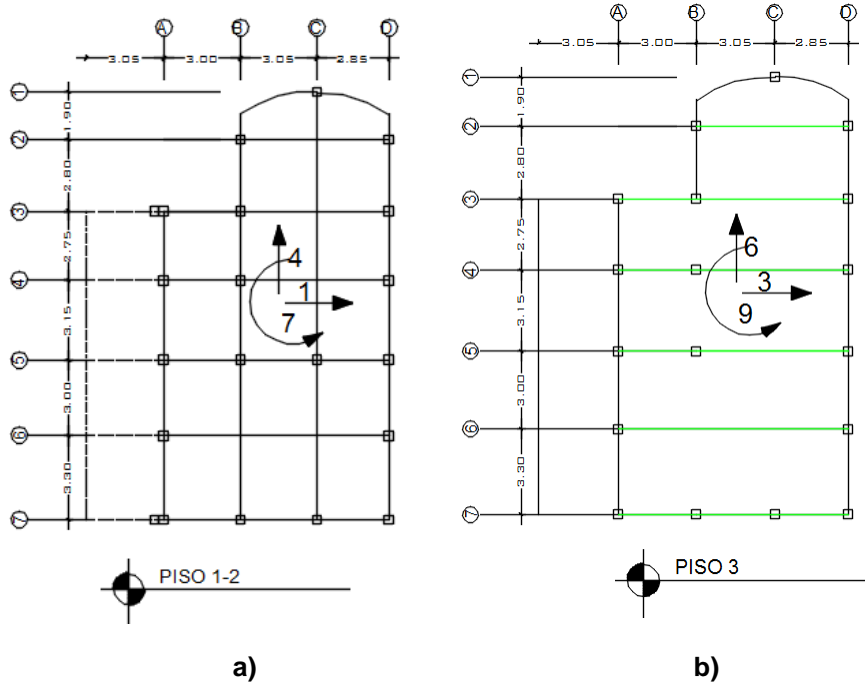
a) Coordenadas de piso en Planta Baja y segunda; b) Coordenadas de piso tercera planta
